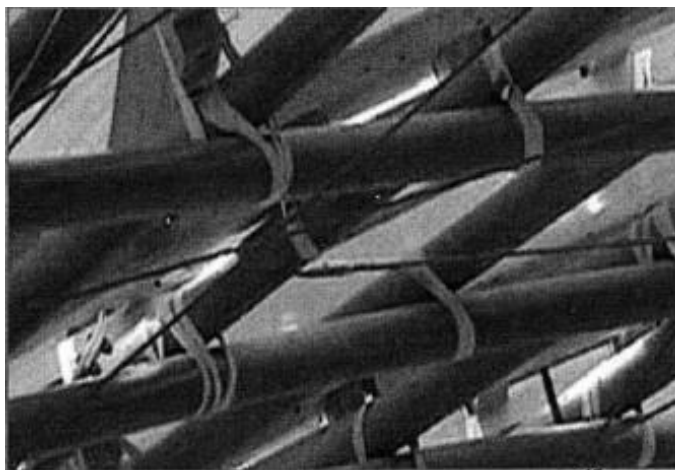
Exemplo de ligação com utilização de fita metálica reforçada (Paoli, 2007)
